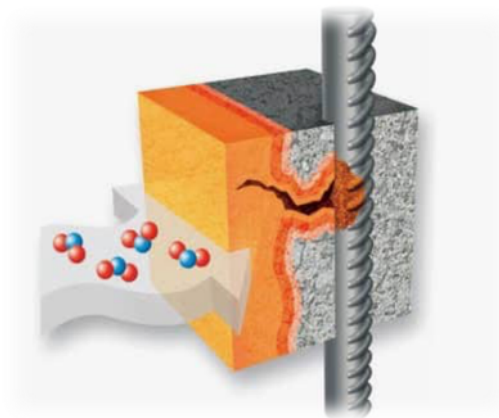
Carbonatación alcanzando armaduras provocando la corrosión.
